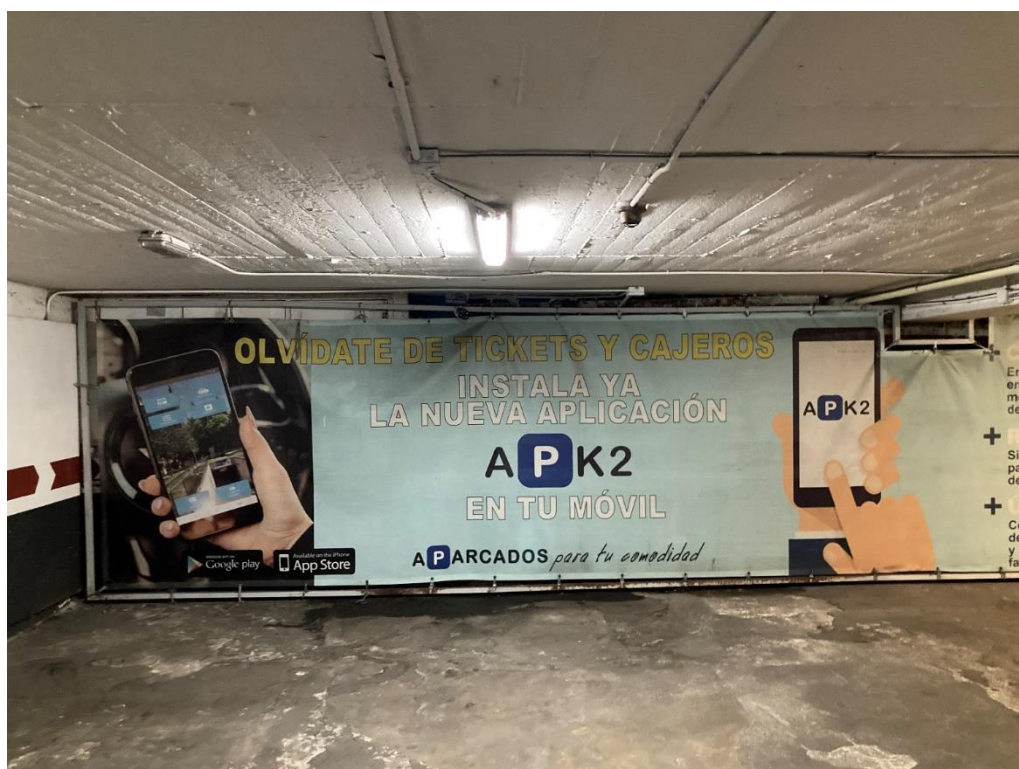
Detalle armaduras vistas losa cubierta
